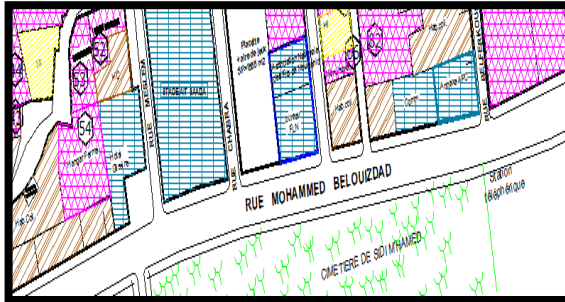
Vue en plan sur la rue Med Belouizded avant l'intervention.
